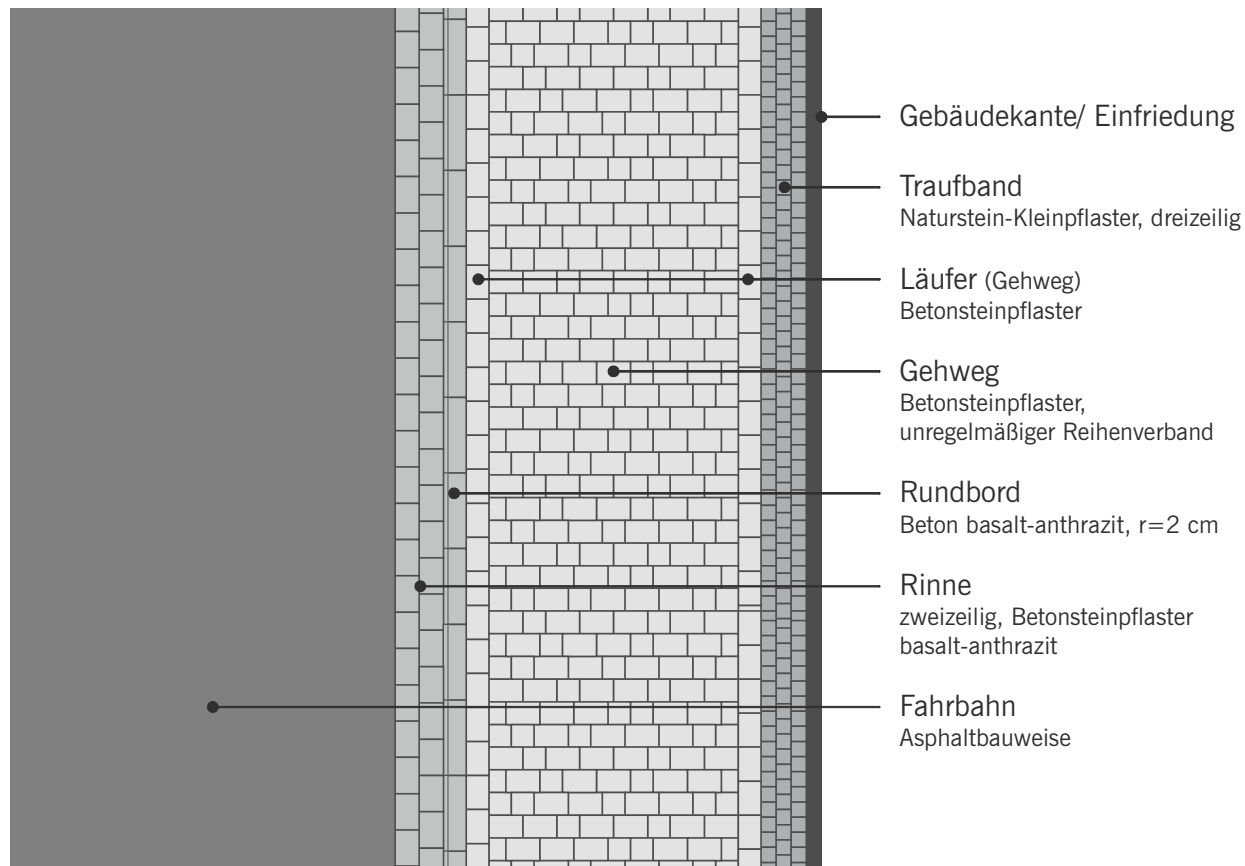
Ausbauprinzip engerer Straßenraumquerschnitt
